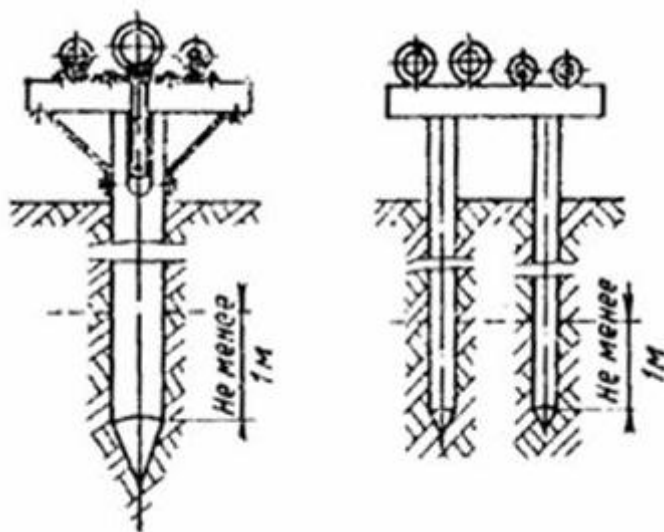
Наземная прокладка трубопроводов на общих свайных опорах
